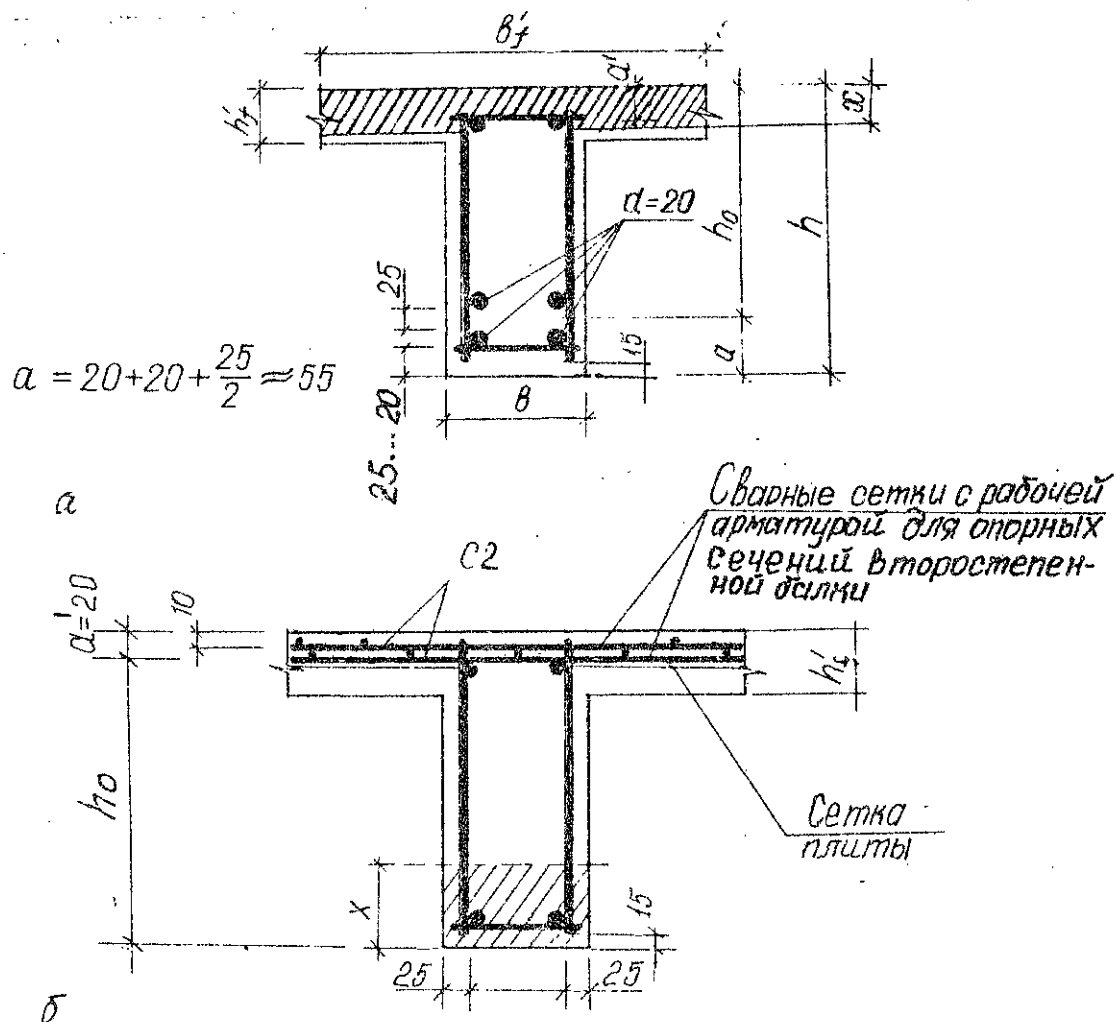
Размещение сварных каркасов и сеток в сечениях второстепенной балки: а - в пролете; б - на опоре
